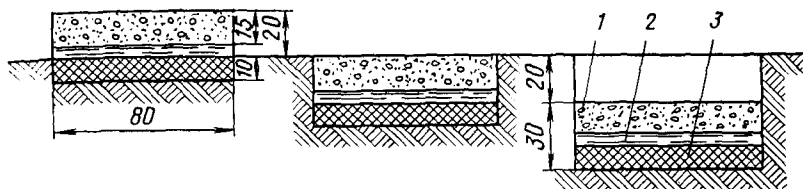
Схема площадок для исследования зональных коэффициентов:
